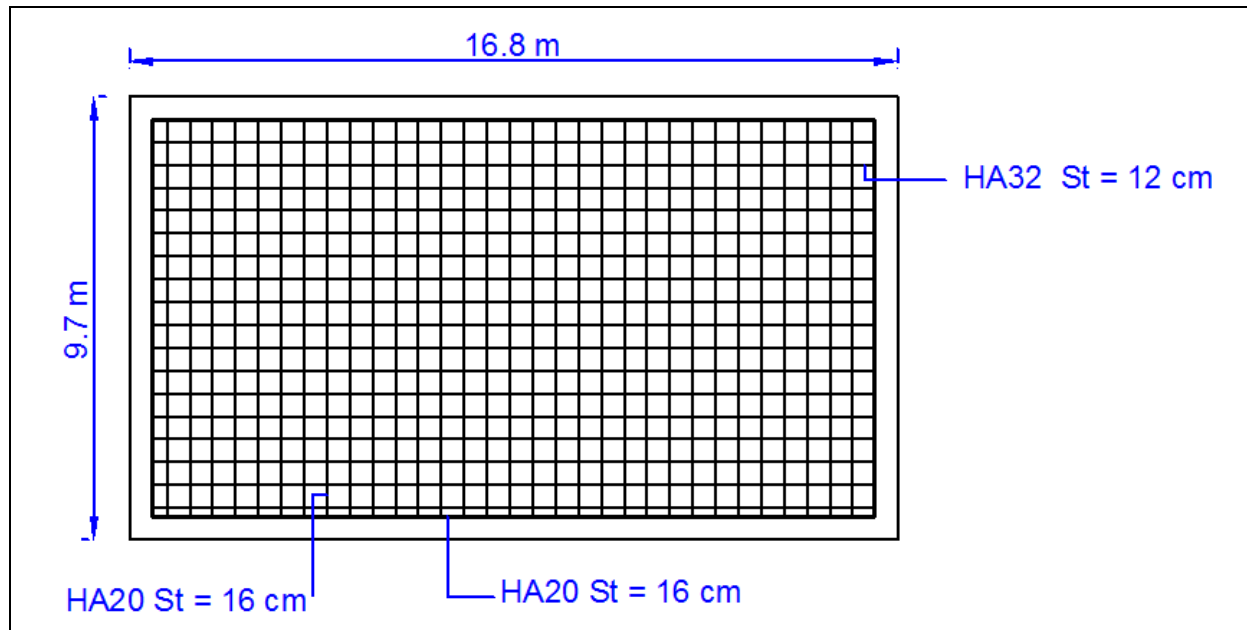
Schéma de ferrailage (nappe supérieure)
